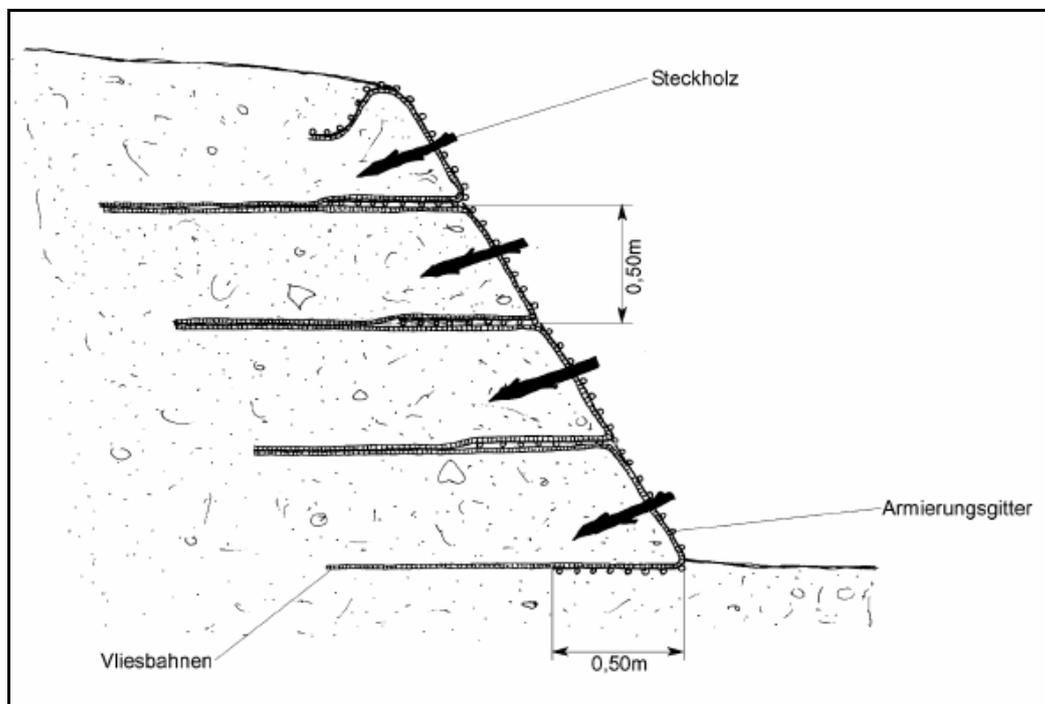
Bewehrte Erde mit Pflanzeinlagen (aus: FLORINETH, 2004)
